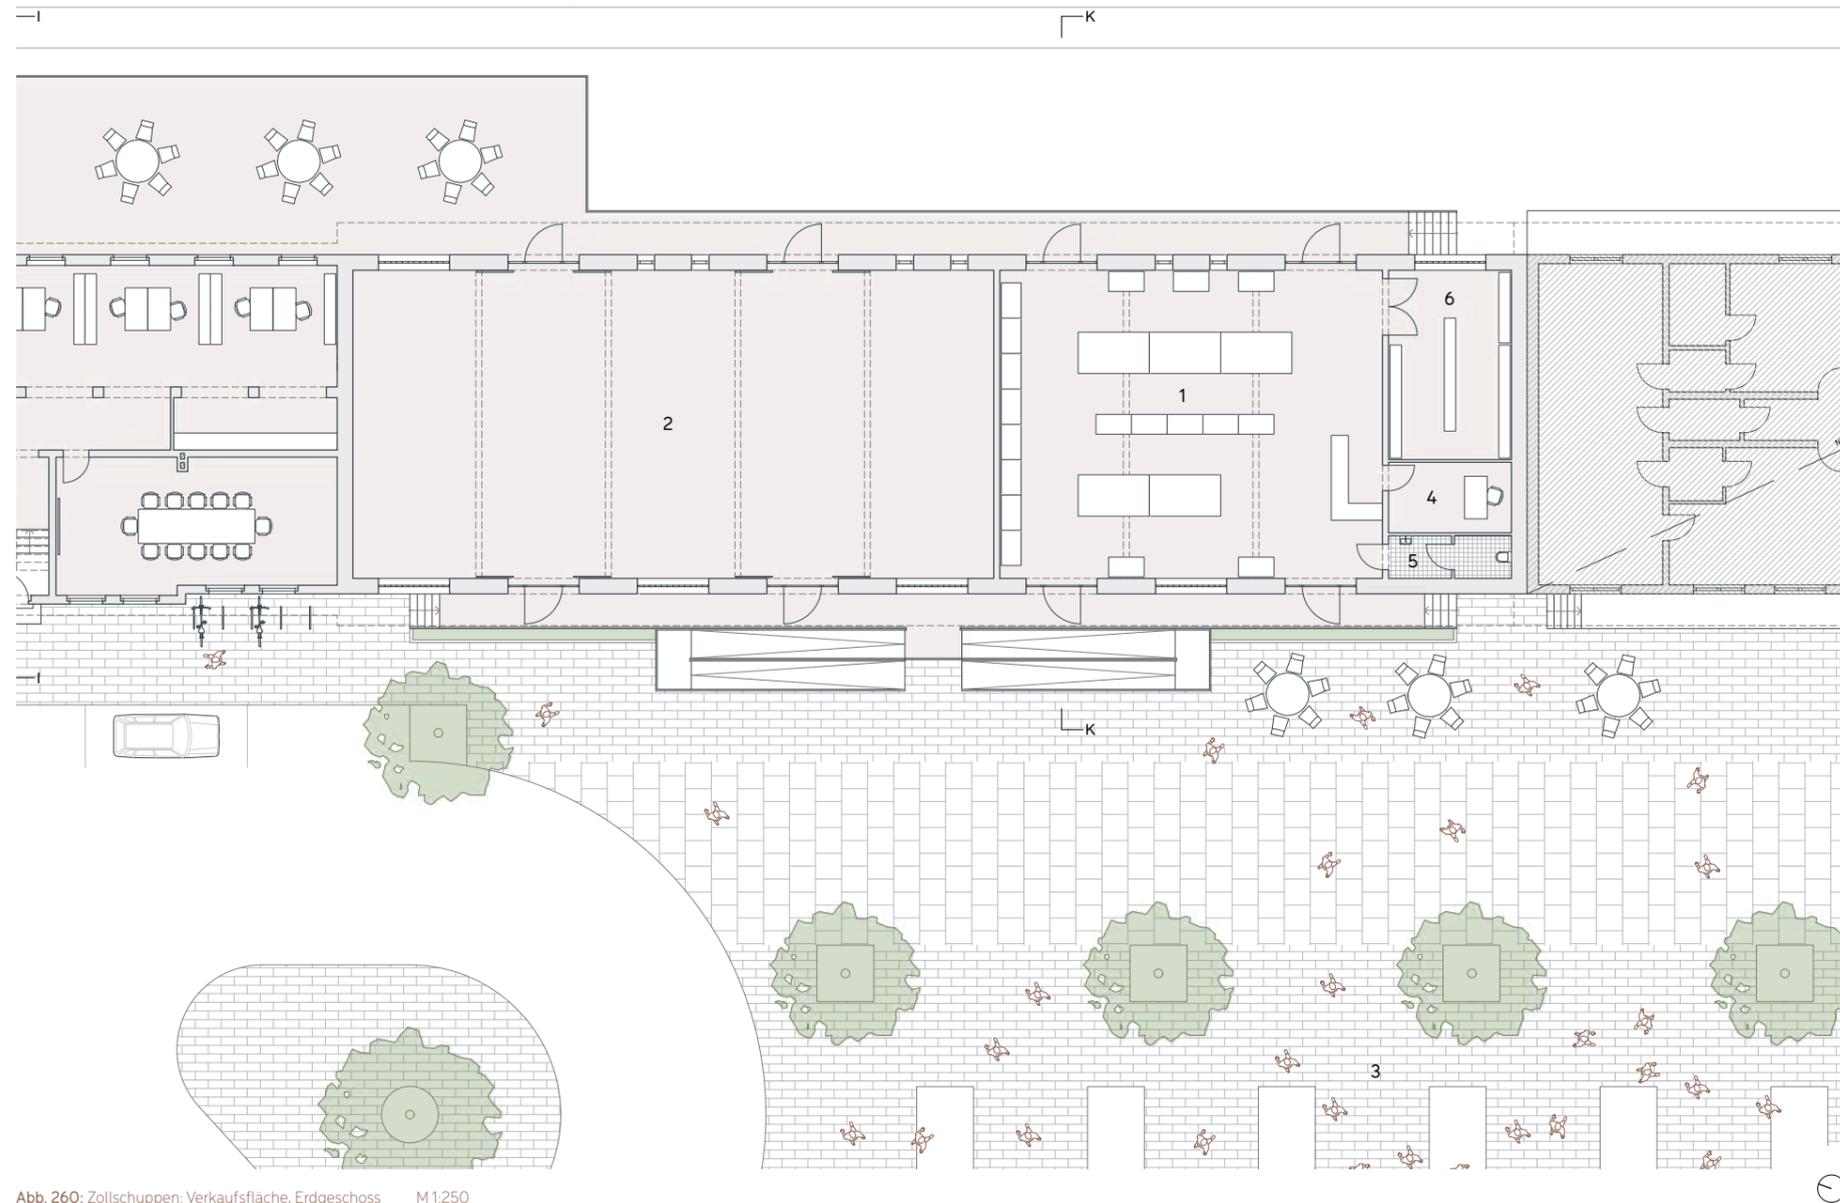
Zollschuppen: Verkaufsfläche, Erdgeschoss M1:250
